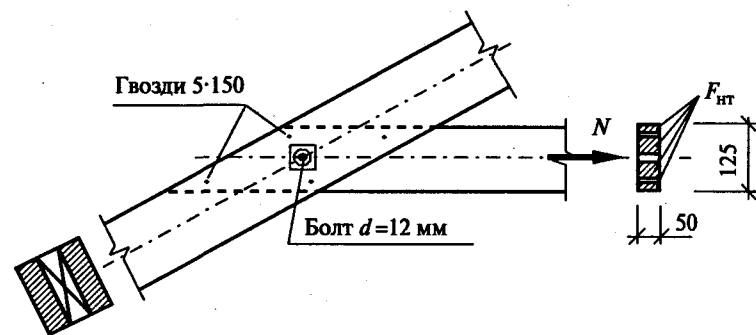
К примеру 6.2. Крепление затяжки к поясу фермы
